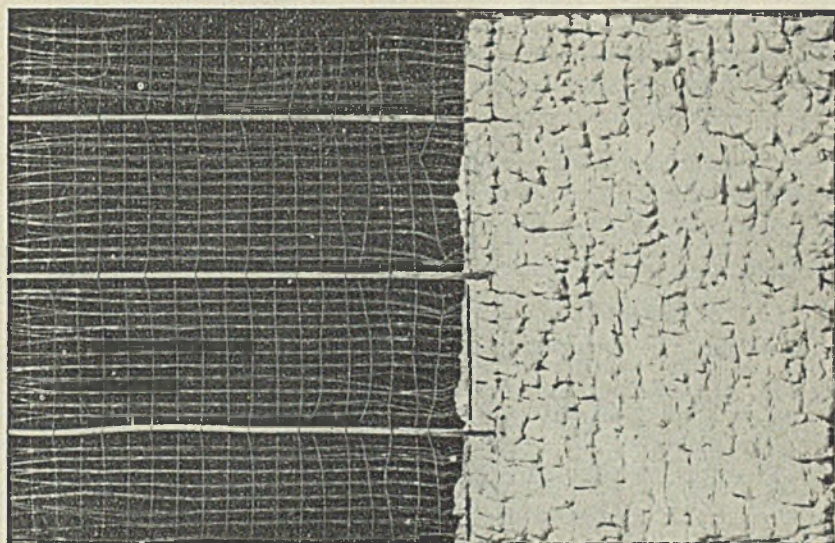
Die Baustahlmatte (Rabidraht mit Armierung).
